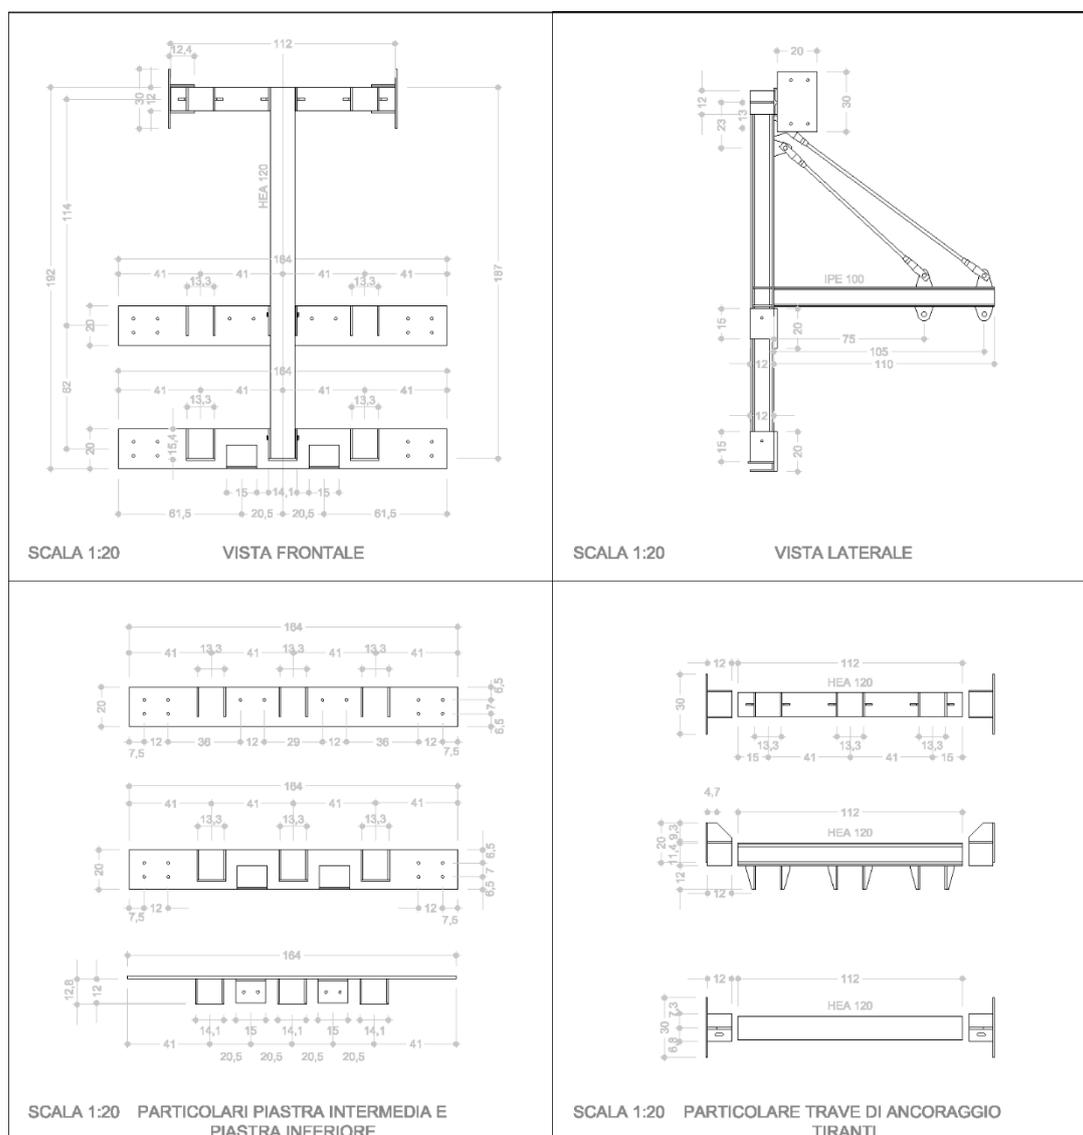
Schema tecnico dell'ancoraggio e distanziatore in acciaio. Vista frontale, laterale e particolari.
